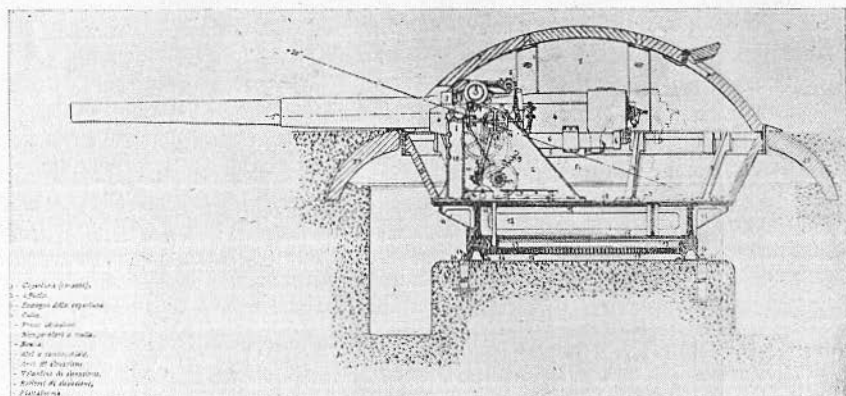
Schema dell'installazione in pozzo da 152/50 in cupola.
